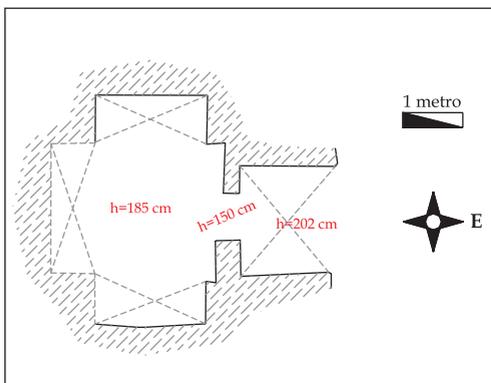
Planta del hipogeo QM C2/14. Tipo 2.1.
